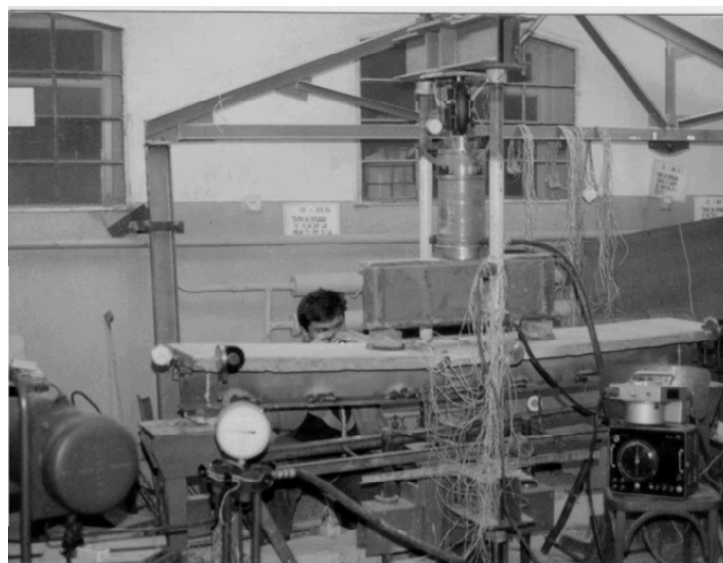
Експериментальне випробування дослідних сталезалізобетонних балкових зразків на силовому стенді
